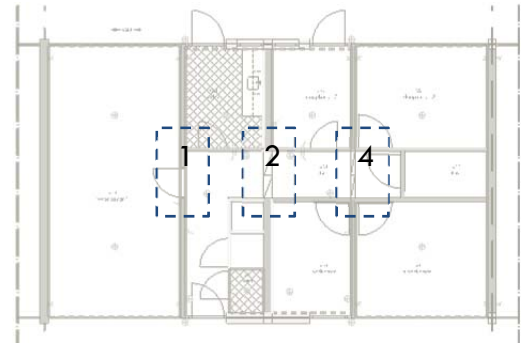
Deel van het nieuwe ventilatieplan, afzuigvoorziening zal niet in de voorzetwanden ondergebracht worden. Maar in de scheidingwand en de ventilatieleidingen worden boven het (toegankelijke) plafond geplaatst. Voor de gehele ventilatieplan wordt verwezen naar tekening V1 in de bijlage.
